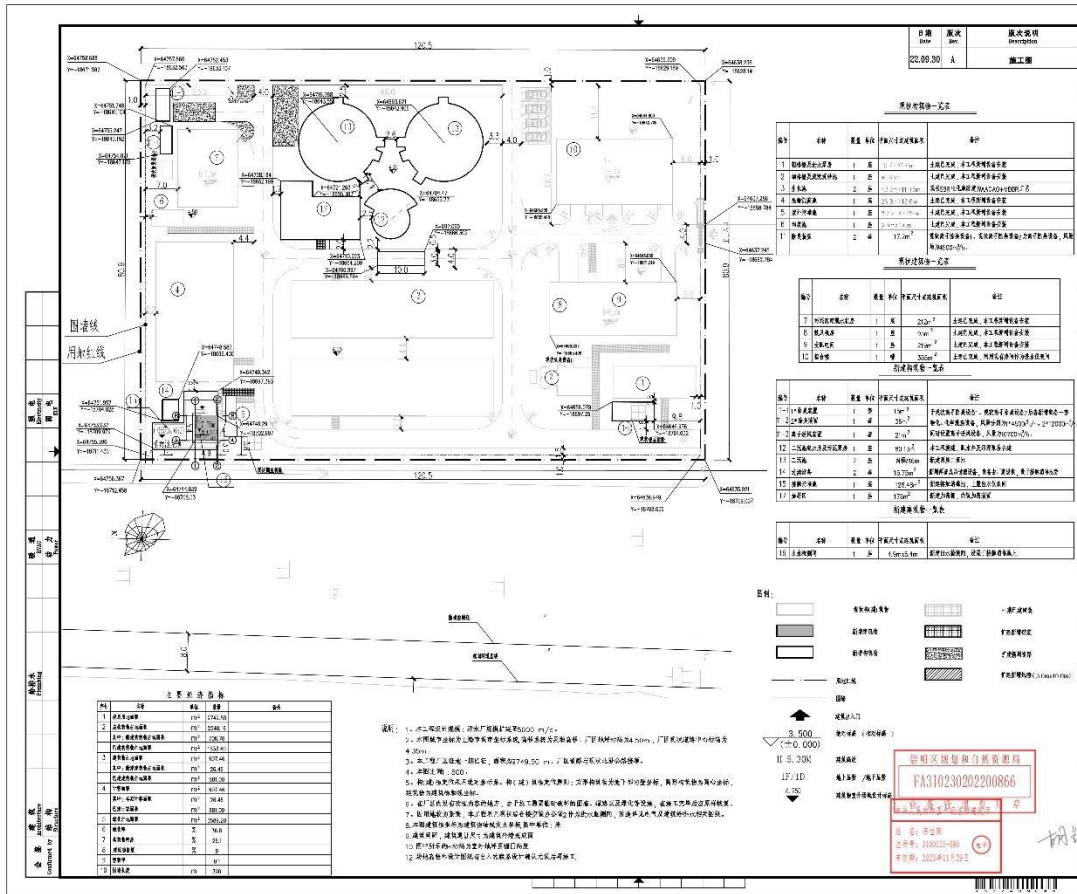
新海镇污水厂提标扩建工程总平面布置图
